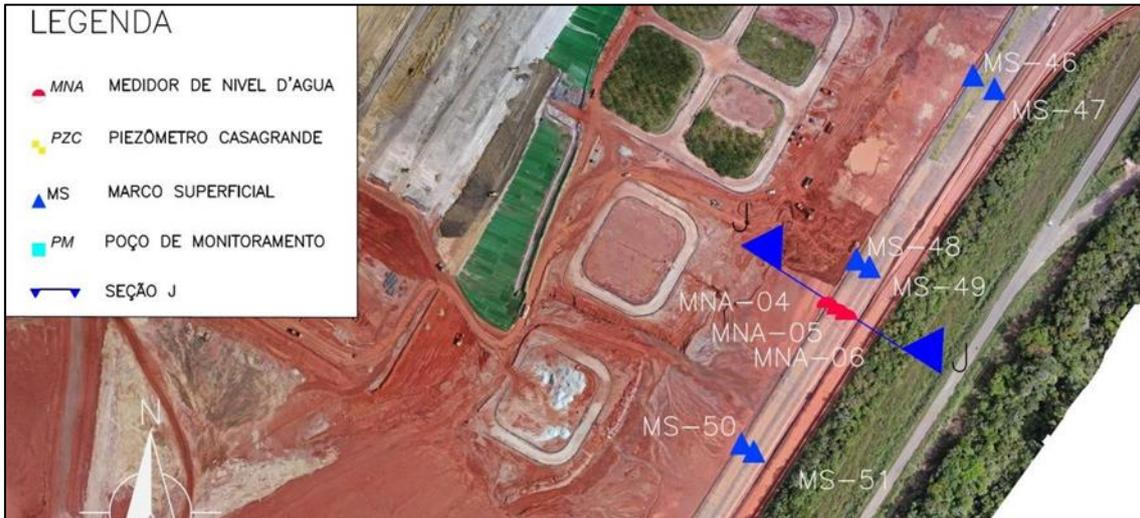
Localização em planta da instrumentação instalada na Seção J (PIMENTA DE AVILA, 2022)
